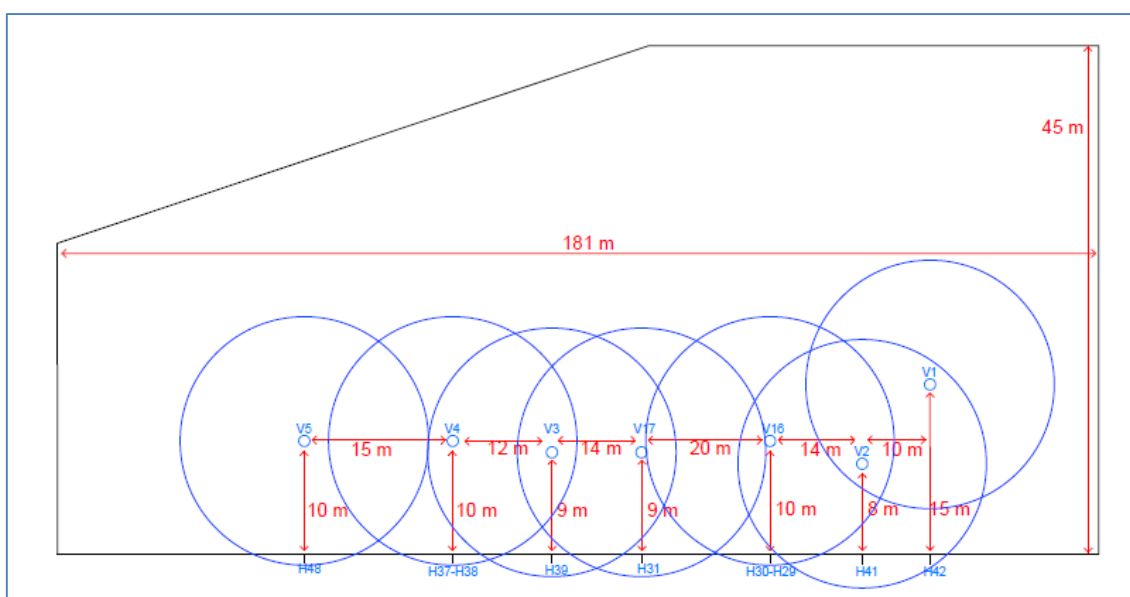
Disposição na zona piloto e raio de influência dos drenos verticais
